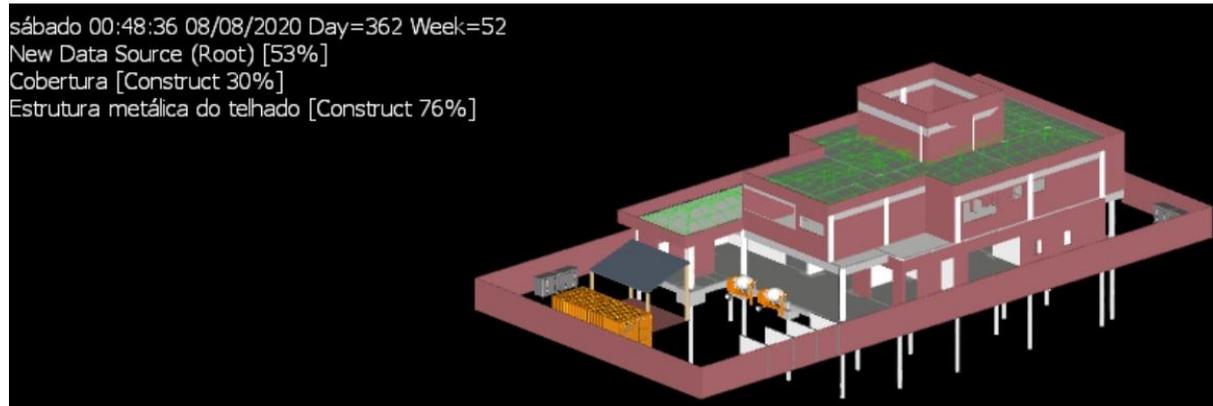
Execução das Estruturas do Telhado (Alvenaria de vedação finalizada)
